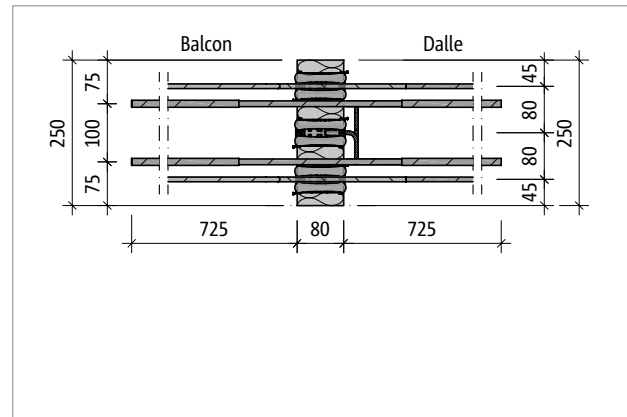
Schöck Isokorb® T Type K-E-M6 : Plan de base du produit de la variante L250
